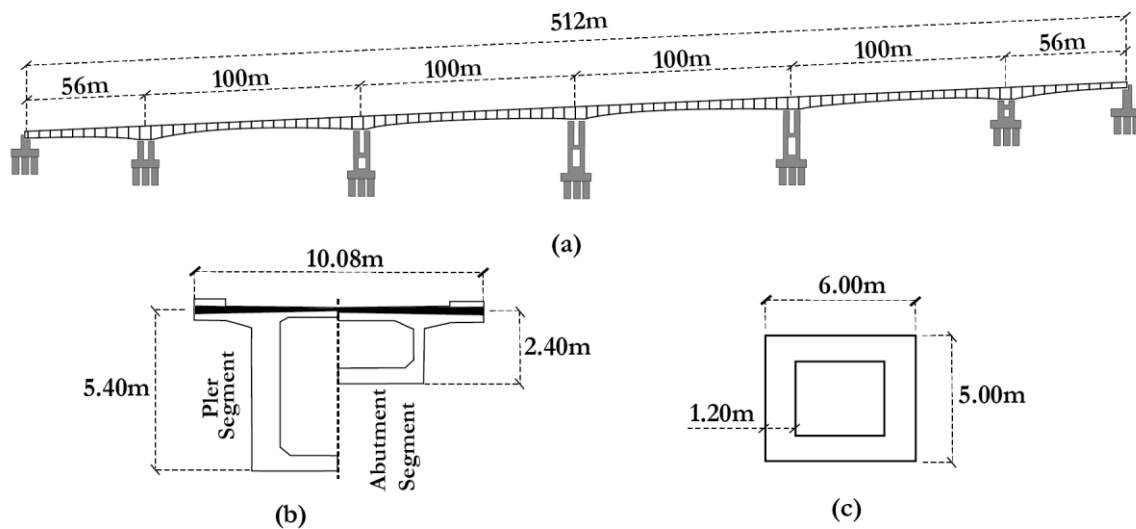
Description du pont routier d'Azazga : (a) profile du pont, (b) coupes transversales des segments, (c) coupes transversales des piles.
